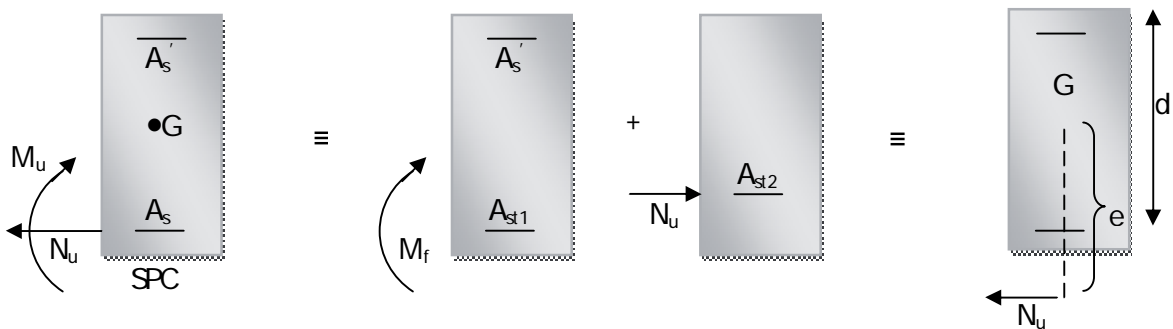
Détermination des armatures d'une section partiellement comprimée
